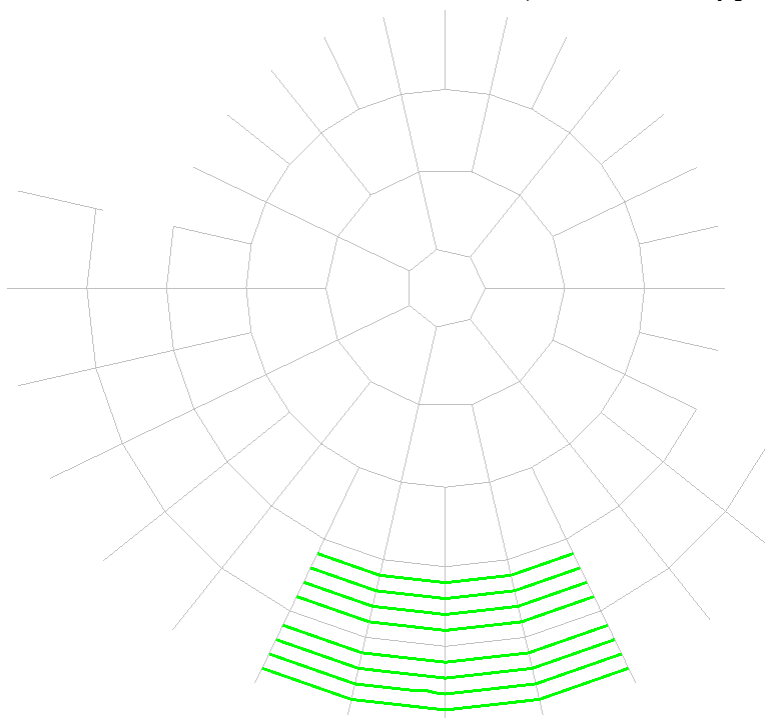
Расчетная схема перекрытия (балок)
